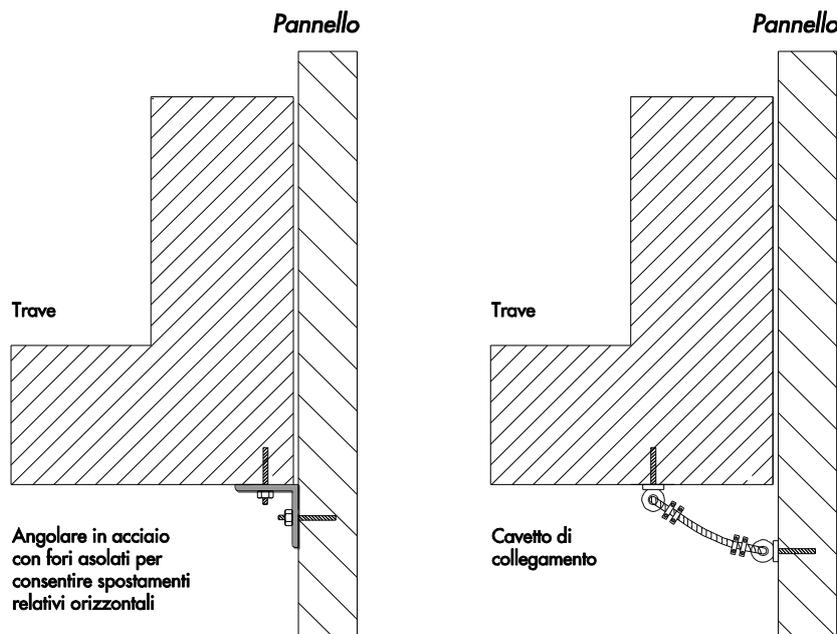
Collegamento trave – pannelli prefabbricati verticali con angolari con fori asolati (sinistra) o cavetti in acciaio (destra).
